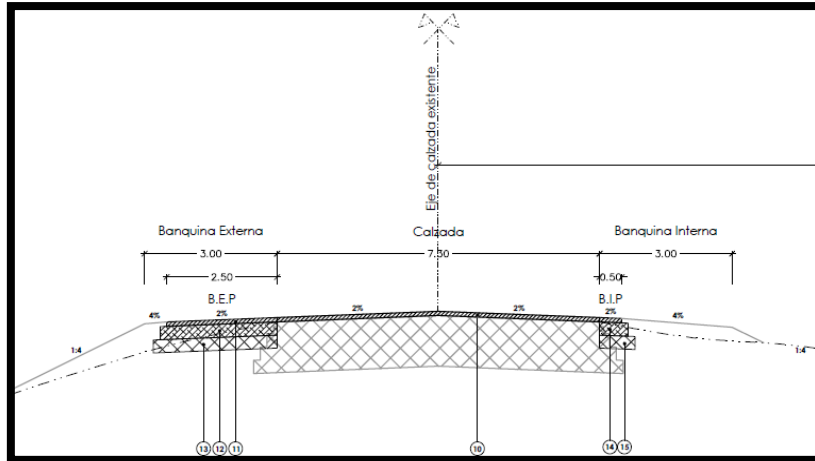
Perfil tipo de pavimento para la Sección 2, PR 0+000 a 30+800.
